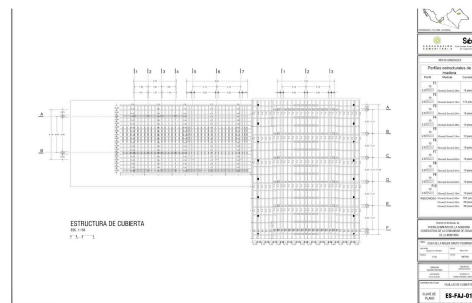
Estructura de cubierta: fajillas (ES-FAJ-01)
